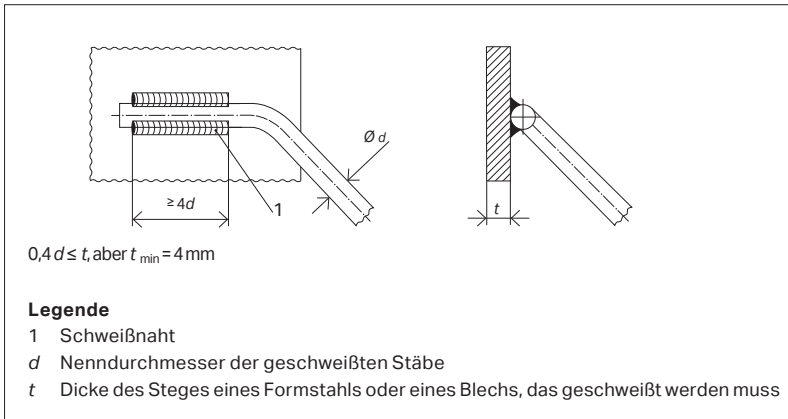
Geschweißte Flankenkehlnaht nach Kap. 6.6.2.1 – Bild 7 und 8
